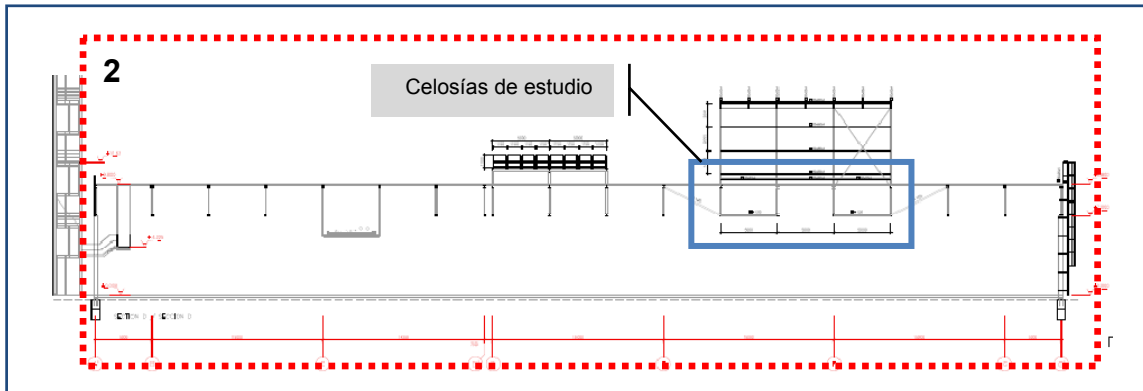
Sección Longitudinal de Zona de ensamblaje
